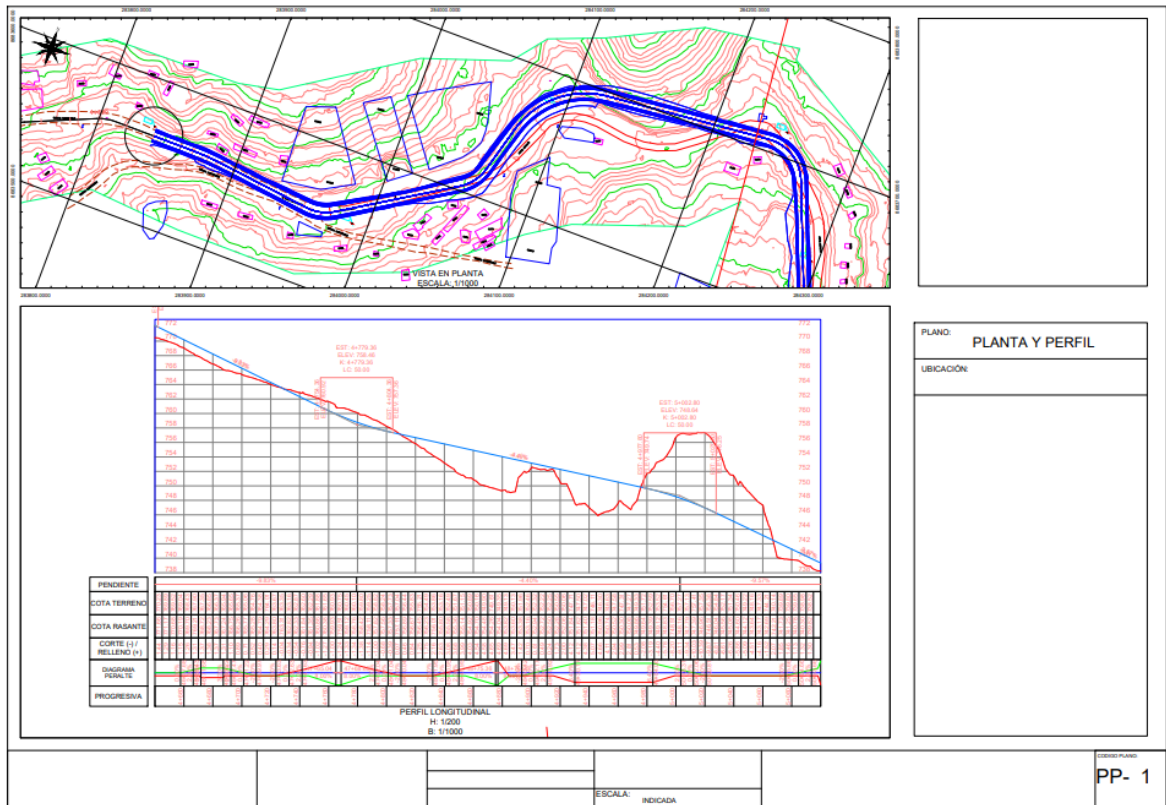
Primera parte de los planos de planta y perfil en civil 3D.
